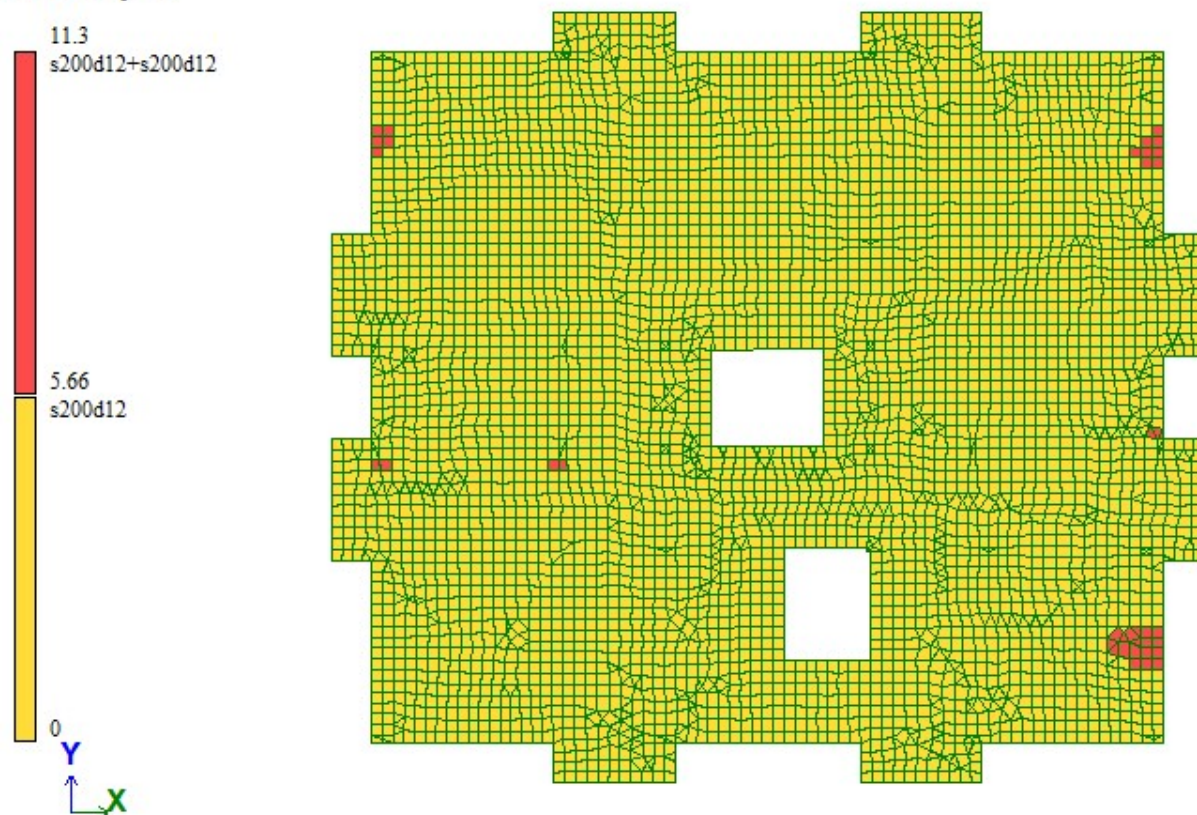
Площадь полной арматуры на 1м по Y у нижней грани
